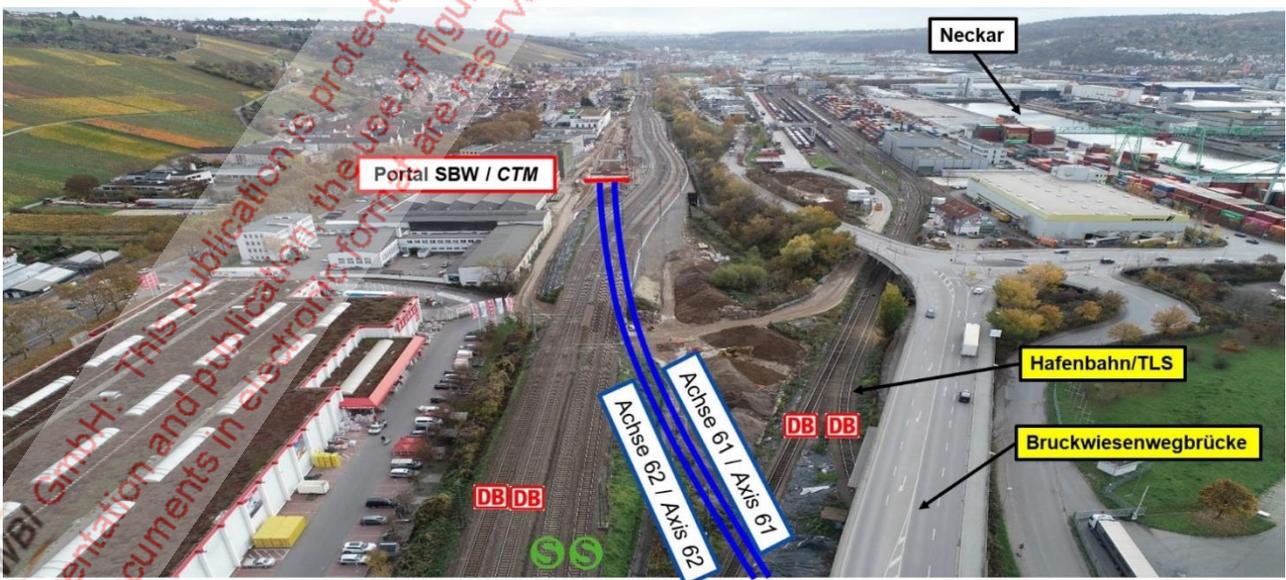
Unterfahrung der Bahnstrecken und Offene Bauweise
